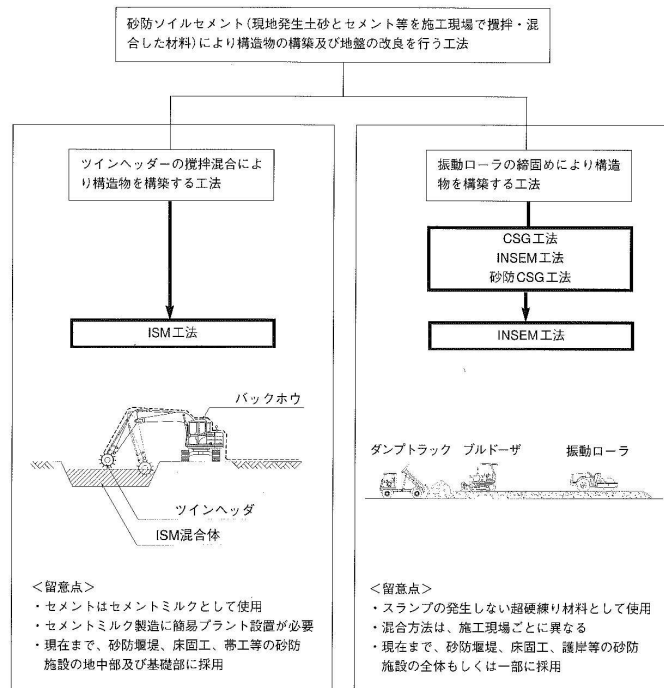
砂防ソイルセメントを活用した工法の分類
